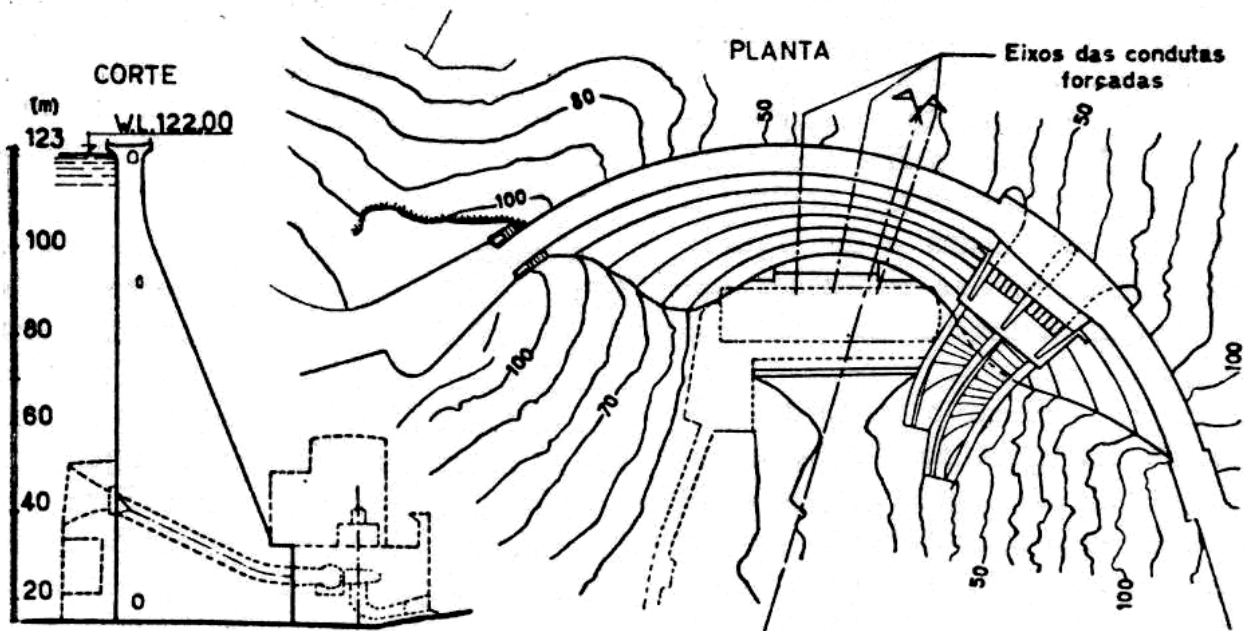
BARRAGEM DE CASTELO DO BODE. Planta e corte
